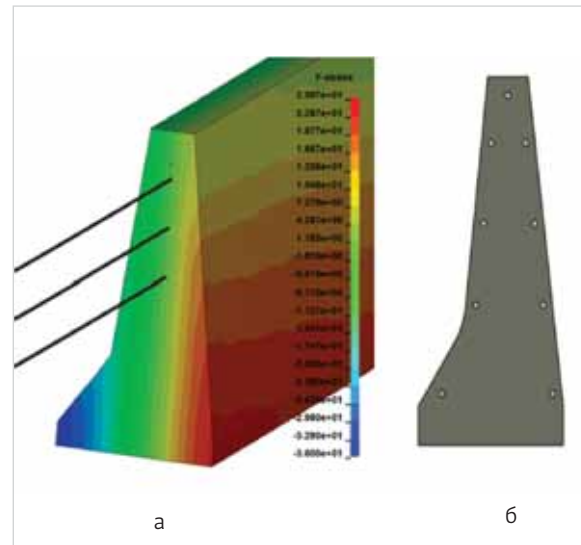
Подбор арматуры: а – НДС существующей конструкции; б – подобранная схема армирования
